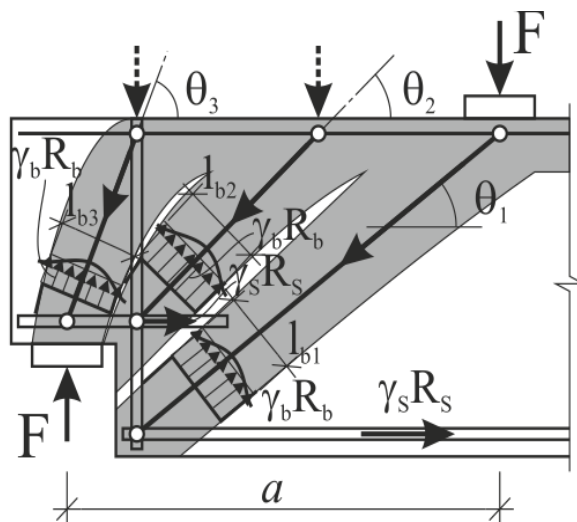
Схема стержневых моделей сжатых полос опорной части балок с подрезкой. Схема предельных усилий в расчетных сечениях наклонных бетонных полос
